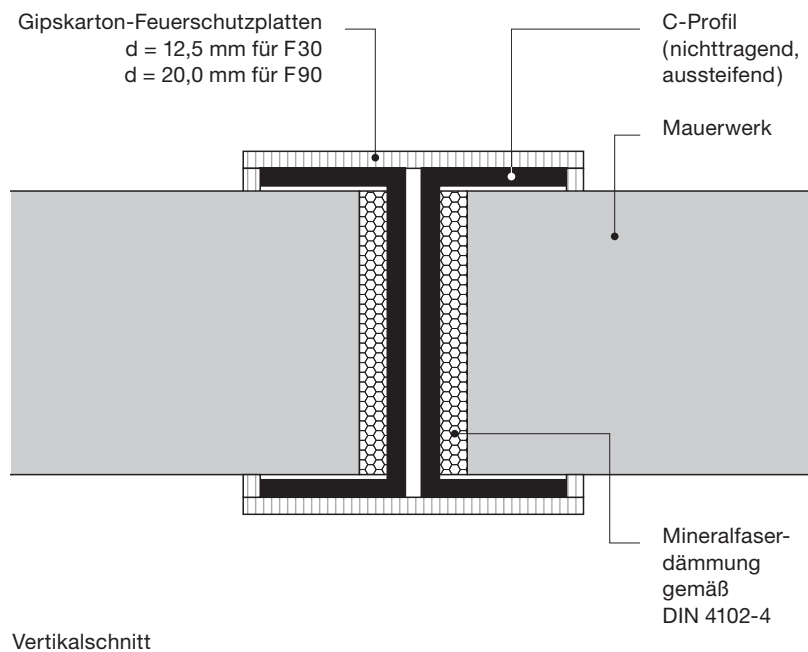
Porenbeton-Mauerwerkswand mit einem brandschutztechnisch bekleideten Stahlprofil, F 30-A bis F 90-A
